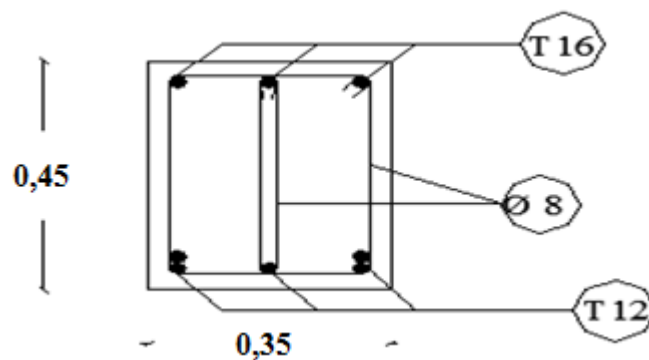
Ferrailage de la poutre principale en travée(sous sol).
